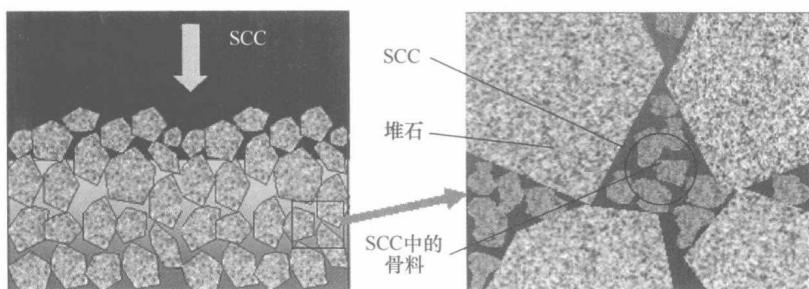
自密实混凝土充填堆石体形成堆石混凝土示意图
